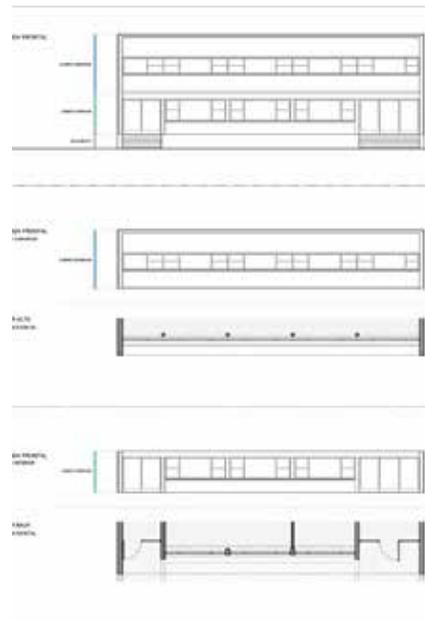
Esquema de ventana corrida en planta alta y ventana liberada en planta baja. ctiva de fachada.
